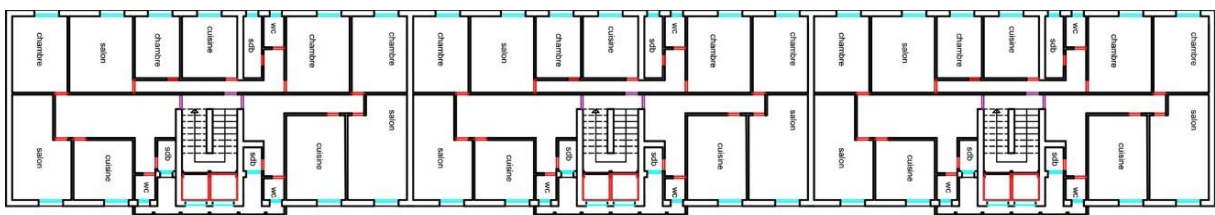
Plan barre étage courant : champs de Manoeuvre
